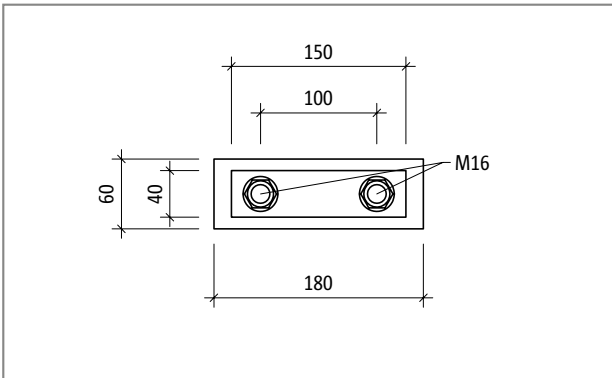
Schöck Isokorb® T Typ S-N-D16: Produktansicht
